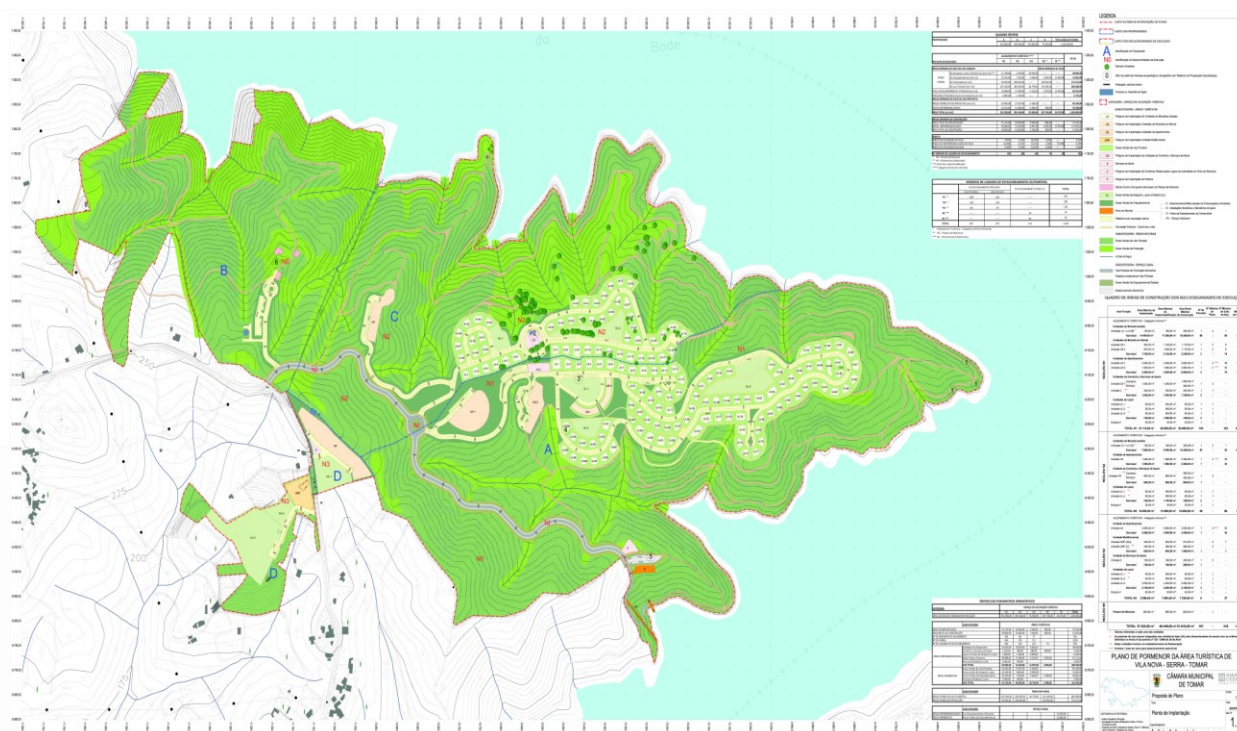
Plano de Pormenor PPVATVNS (fonte: C.M.T, 2011)
